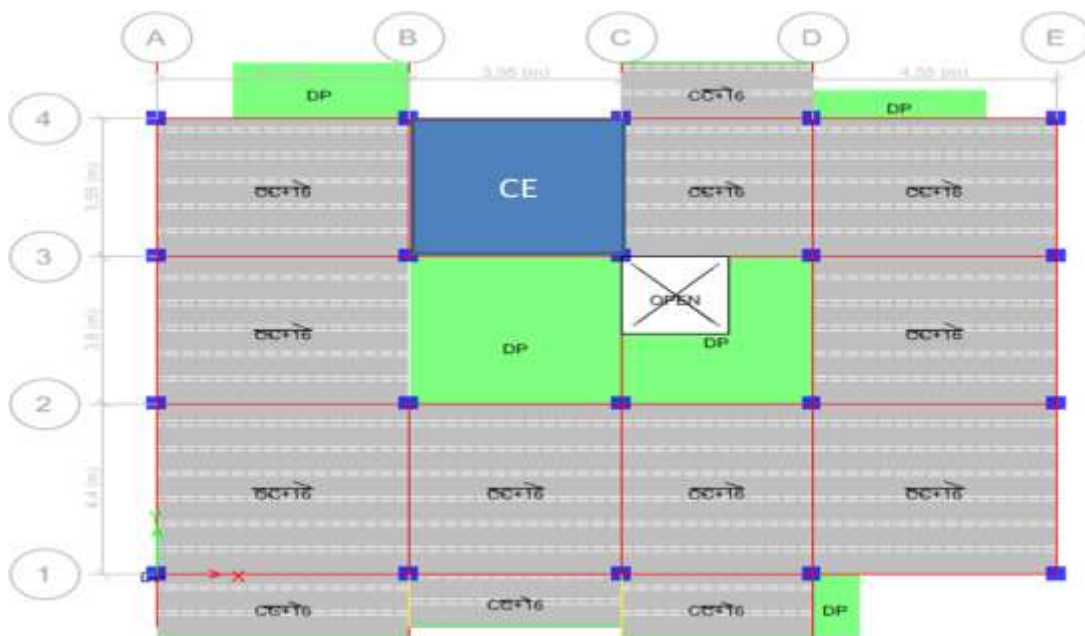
Plan de disposition des poutrelles (Etage 06)
